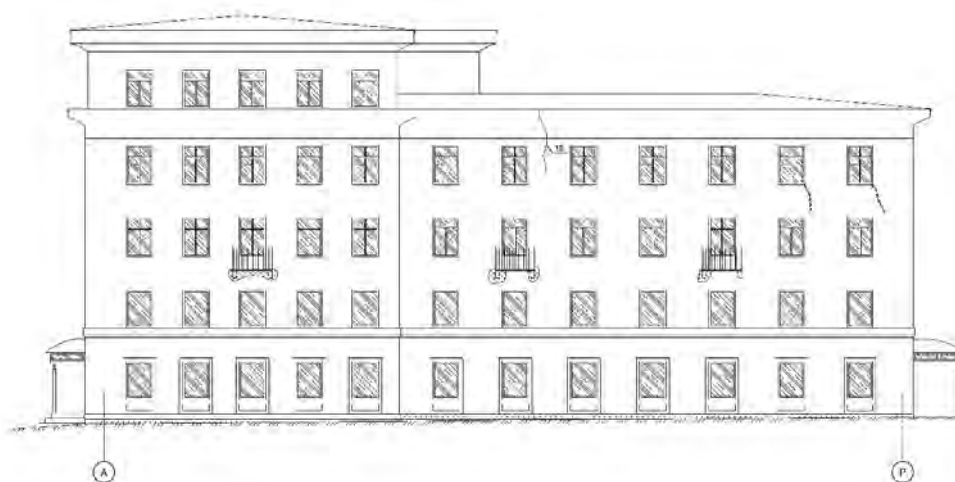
Фасад, выходящий на улицу Ново-Садовую
